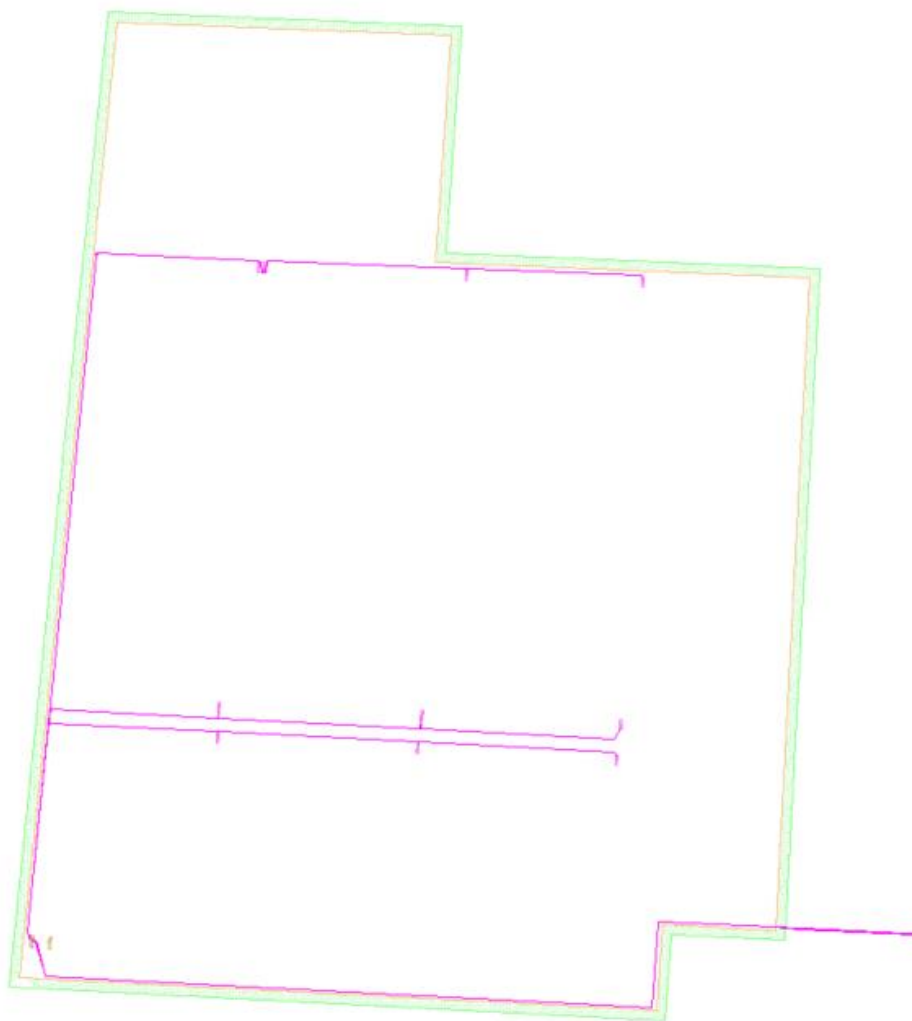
planimetria cavidotti su layout - sottocampo ovest
